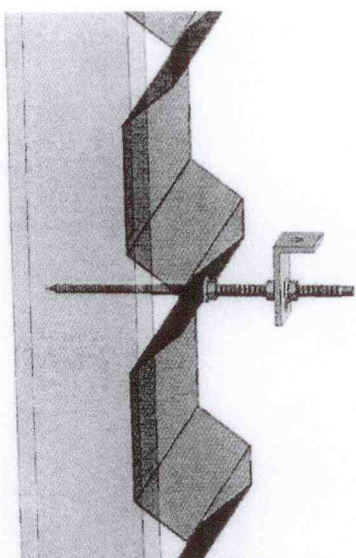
Montierte Stockschraube mit „Montagewinkel S“
